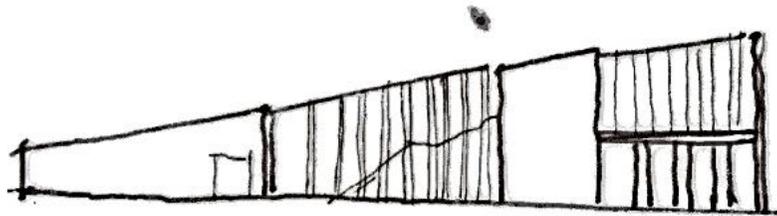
Propuestas de Fachadas en croquis.
